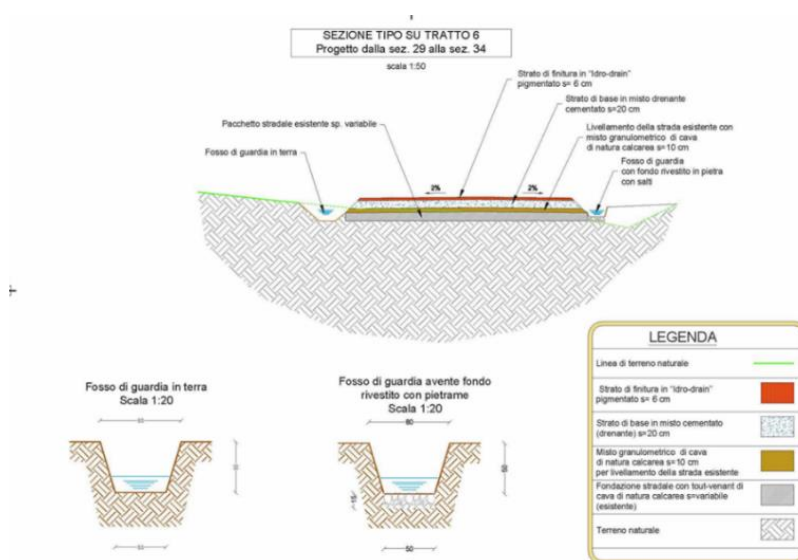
Sezione tipo stradale in corrispondenza dei tratti di elevata pendenza
